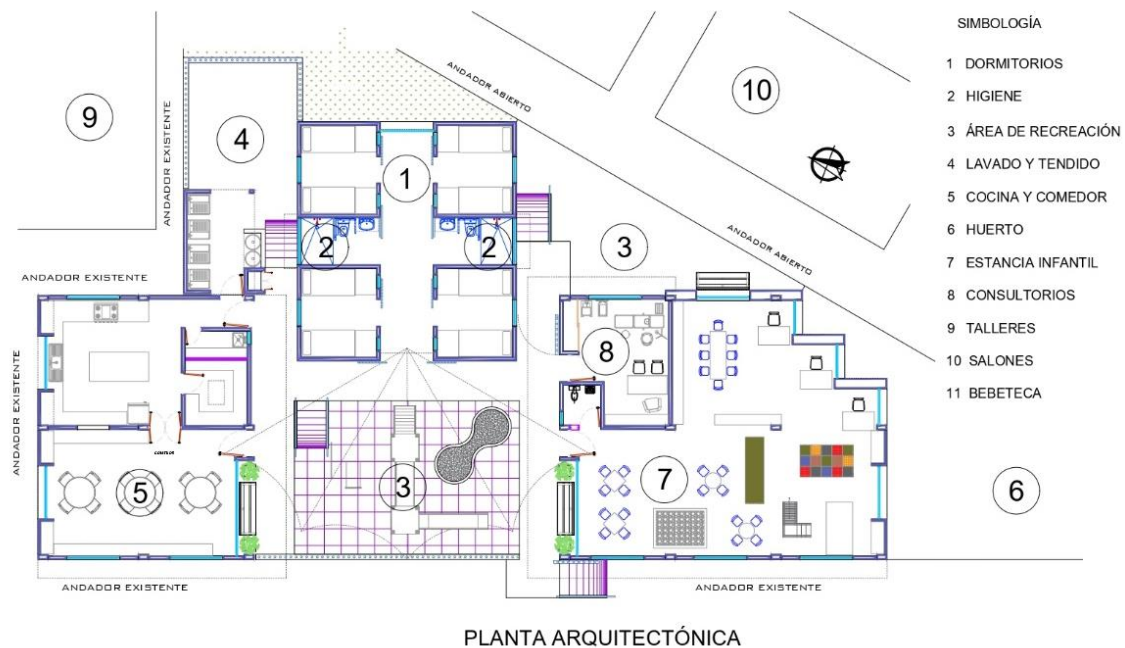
Planta arquitectónica del espacio de convivencia para mujeres con infantes en prisión, elaboración propia, 2023.
